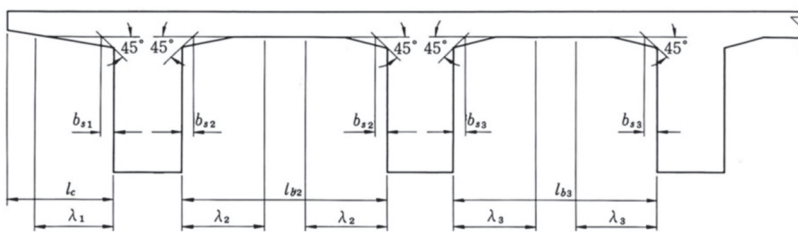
圧縮フランジの片側有効幅(主桁の場合)
